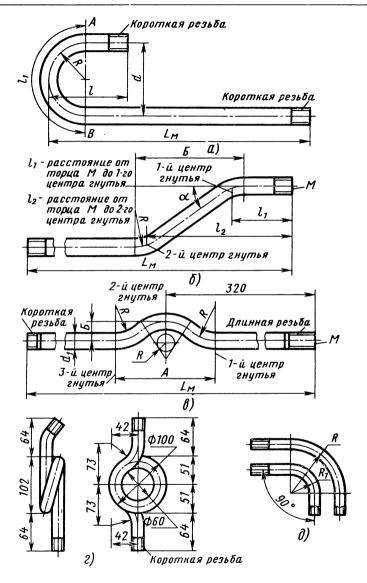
Виды гнутых труб: a — калач; δ — утка; ϵ — скоба; ϵ — кольцо; δ — отводы
